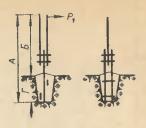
Деревянная бесфундаментная опора ДБ. 1—подвеска; 2—брус; 3—связь; 4—основание; 5—опора.
